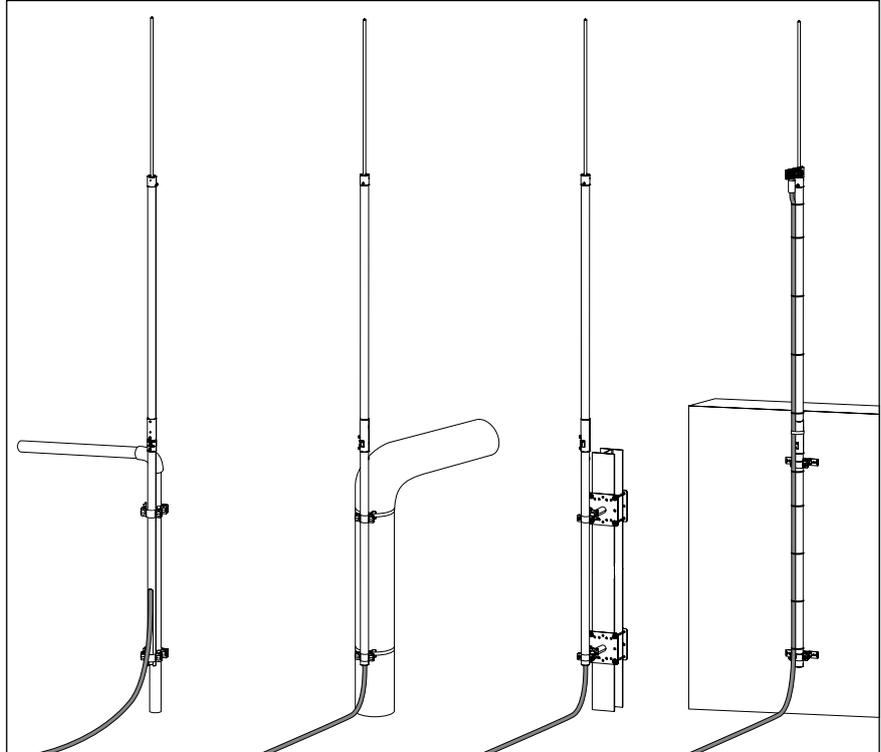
Fangmasten an Rohren, Wänden oder T-Trägern befestigen
